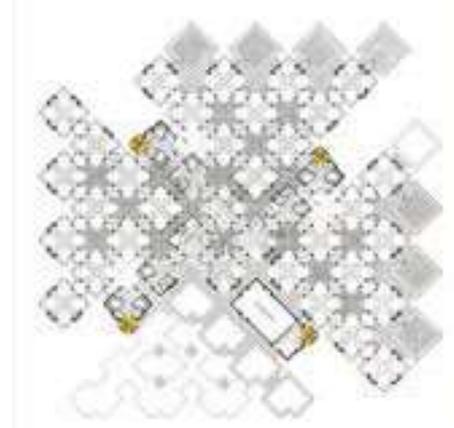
Herman Hertzberger, Centraal-Beheer Bürogebäude, Grundriss des 4. Obergeschosses. 1968-72. Auf den 4. und 5. Obergeschoss befinden sich zweigeschossige Büros.
